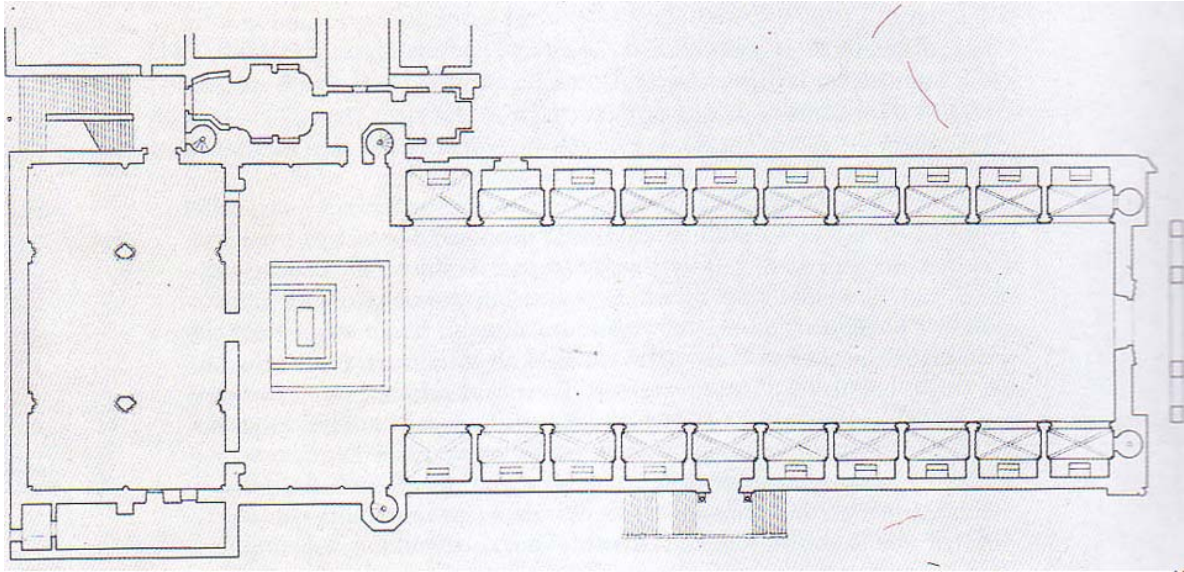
Neapel, S. Chiara, Grundriss
